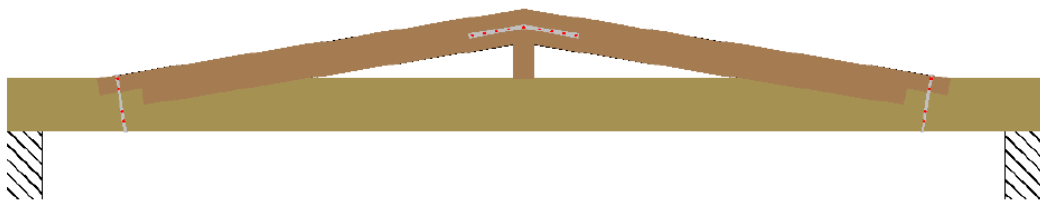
Viga com reforço de madeira (Pires, 2009)
